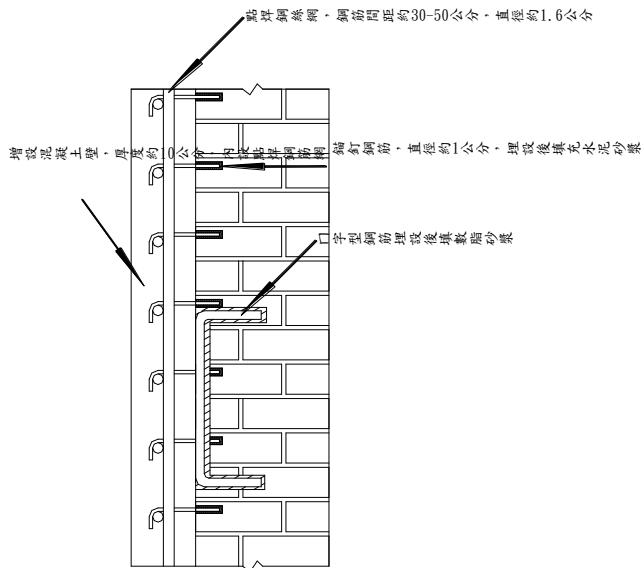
牆體利用鋼筋混凝土增加厚度示意圖
